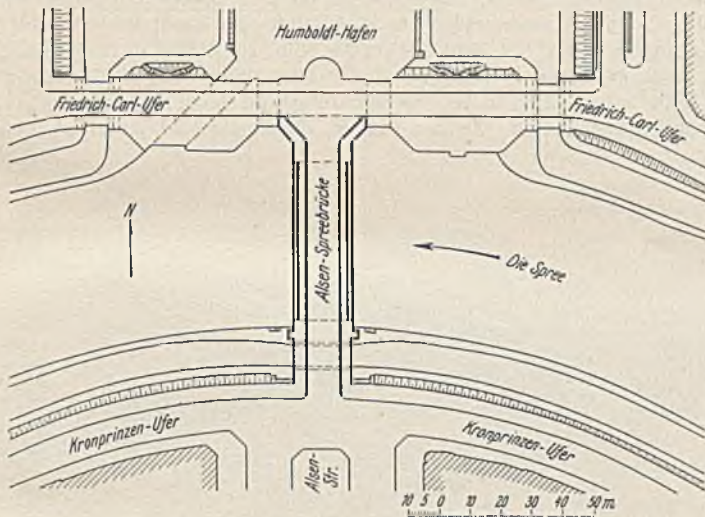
Alsenbrücke 1899 bis 1925. Lageplan.
